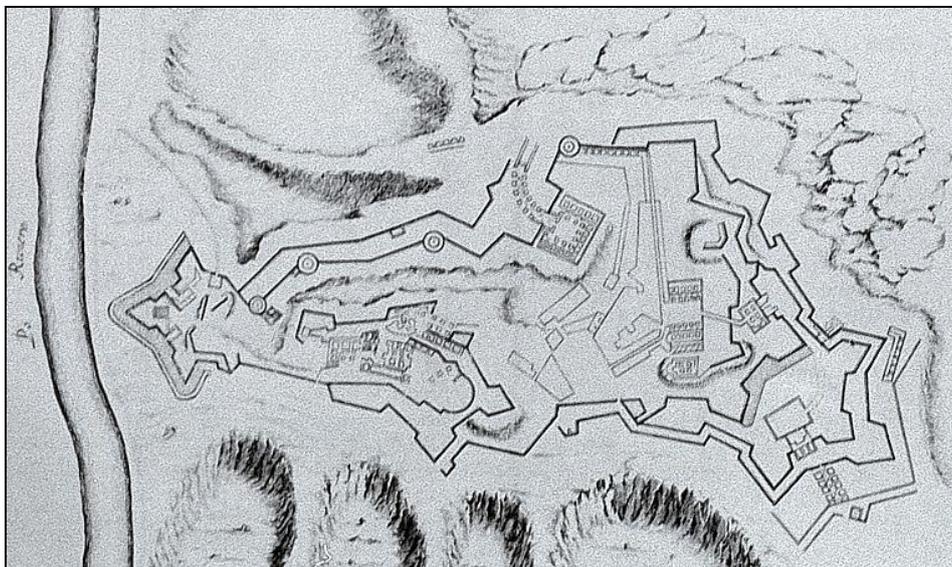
ca. 1680: Anonimo, PLANIMETRIA DELLA FORTEZZA. E' la prima planimetria del forte dopo i lavori di consolidamento e di ristrutturazione. Appare qui ben evidente nel castello la grossa costruzione semicircolare denominata poi "Dongione", ancor oggi esistente, mentre l'edificio ecclesiale è già in fase di trasformazione.
